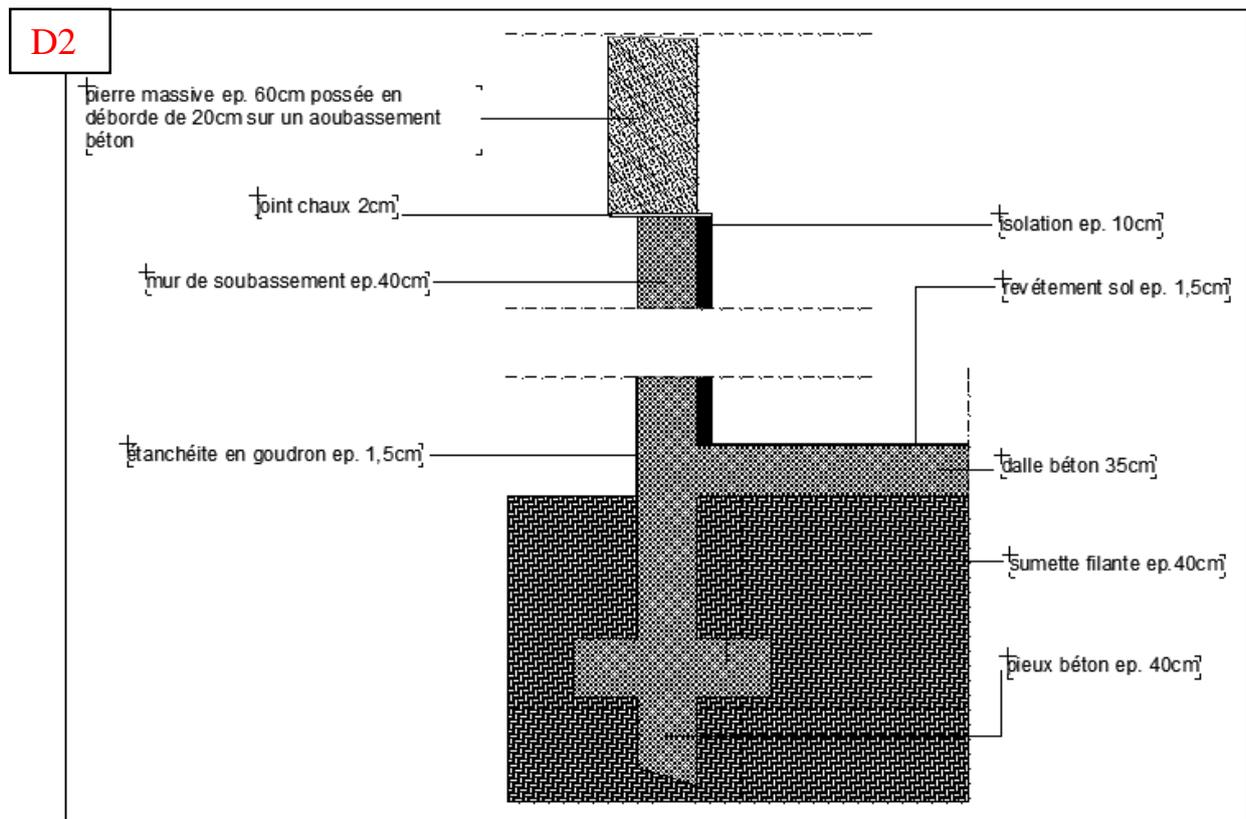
Détail de construction d'un mur de soutènement et semelle filante (source : auteur).
